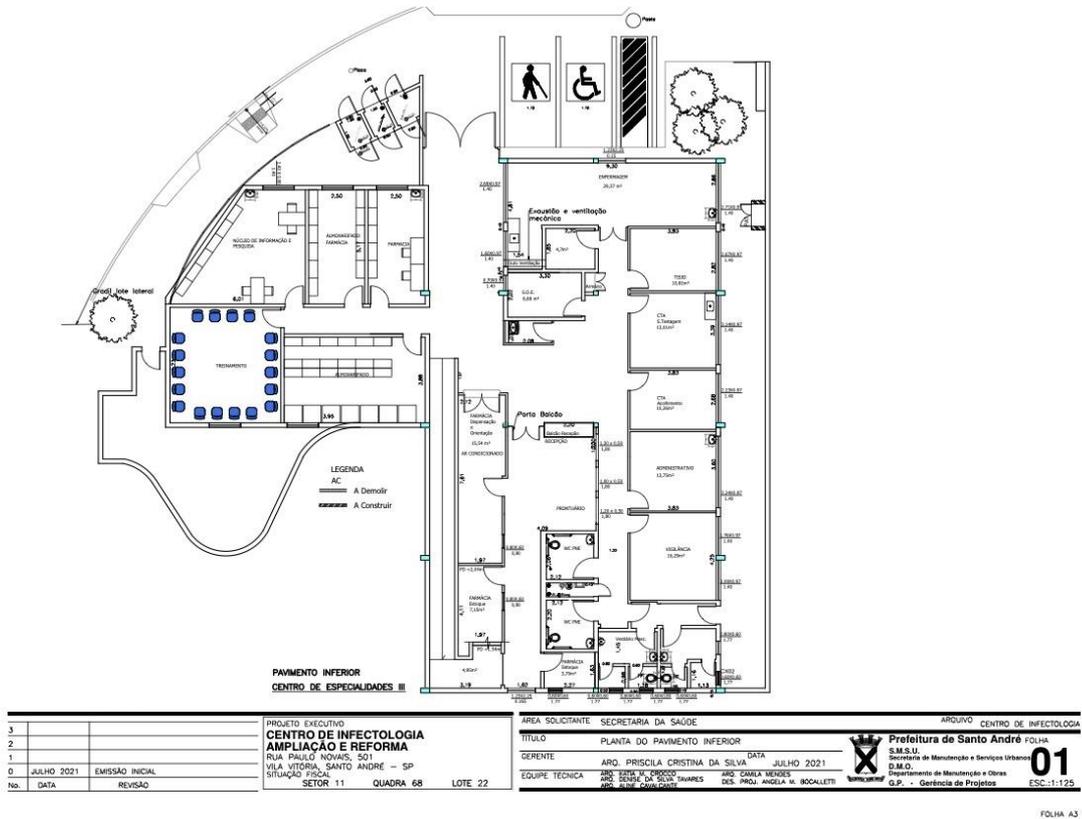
Centro de Infectologia de Santo André. Planta do pavimento térreo.
